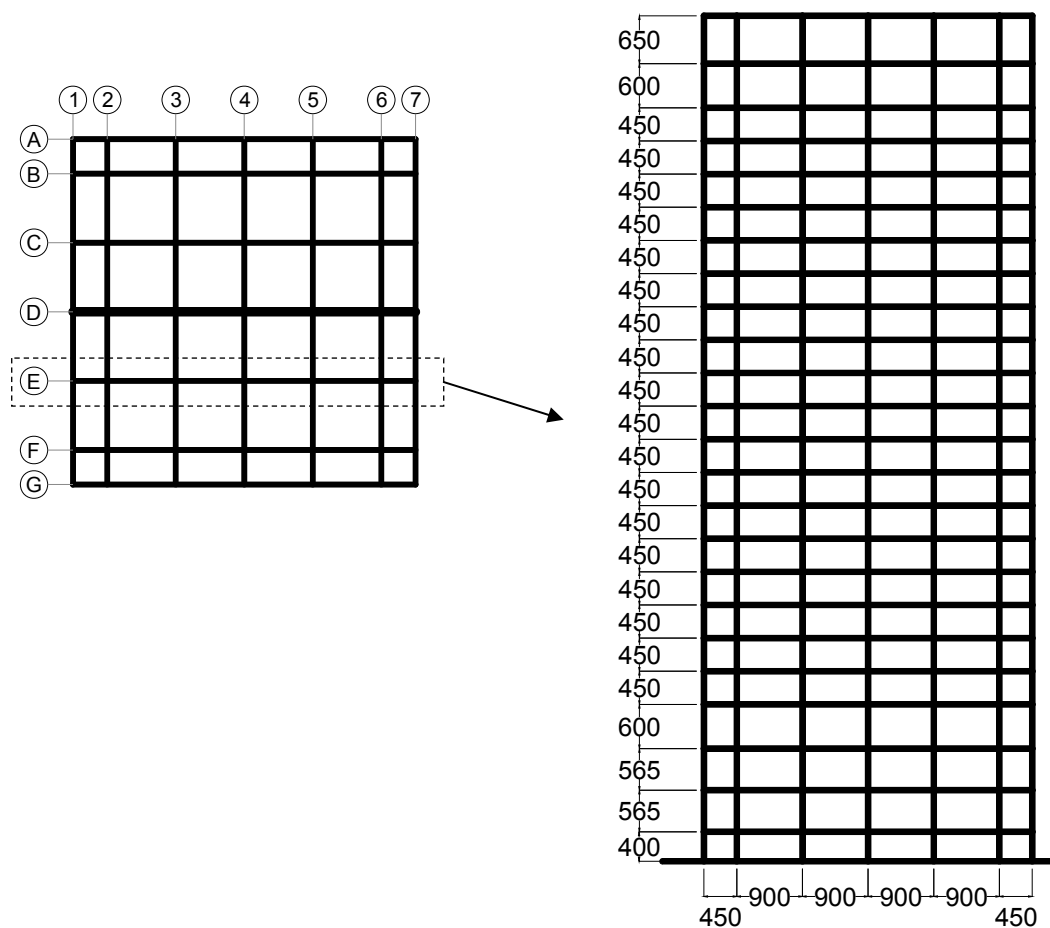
Planta Estructural y Alzado Marco Gravitacional
